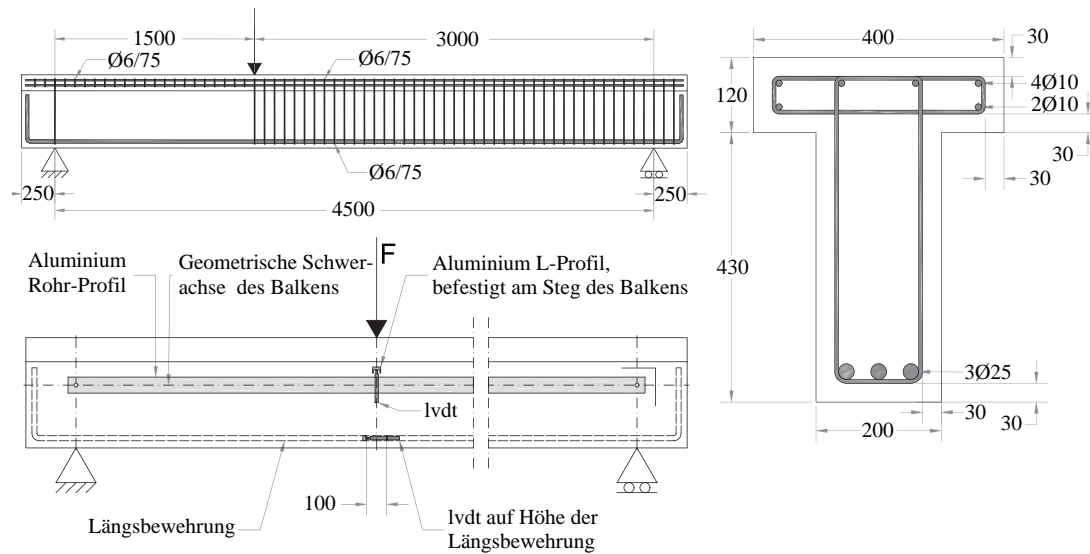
Dimensionen und Bewehrung des Stahlfaserbetonbalkens als Großprüfkörper (alle Maße in mm) [75, S.3]
